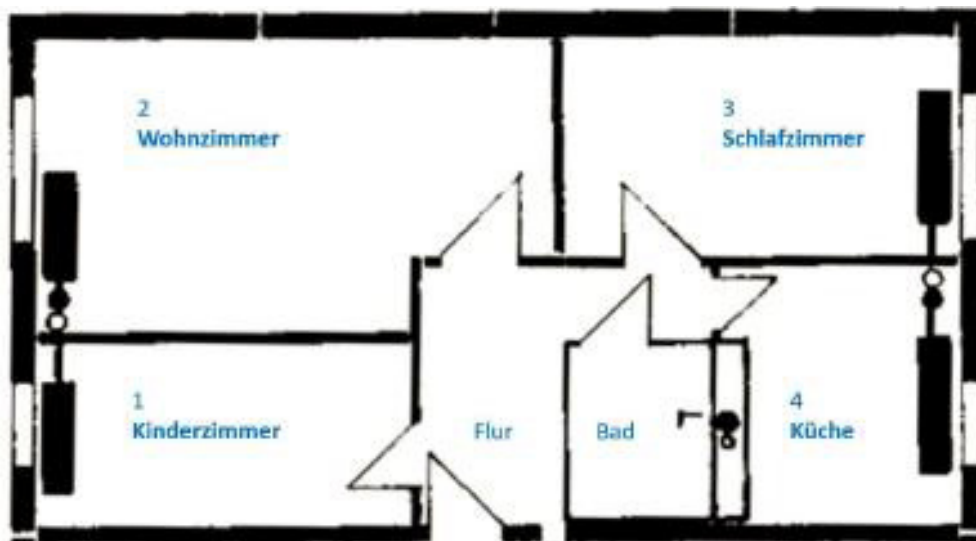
Grundriss 3-Raum-Wohnung Kleinsteinberger Straße 22 in 04824 Brandis
